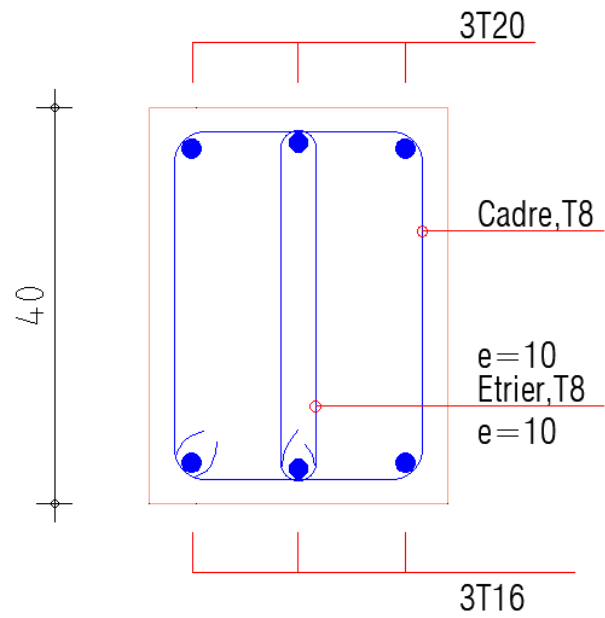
Ferrailage de poutre principale RDC → 7ème (travée).
